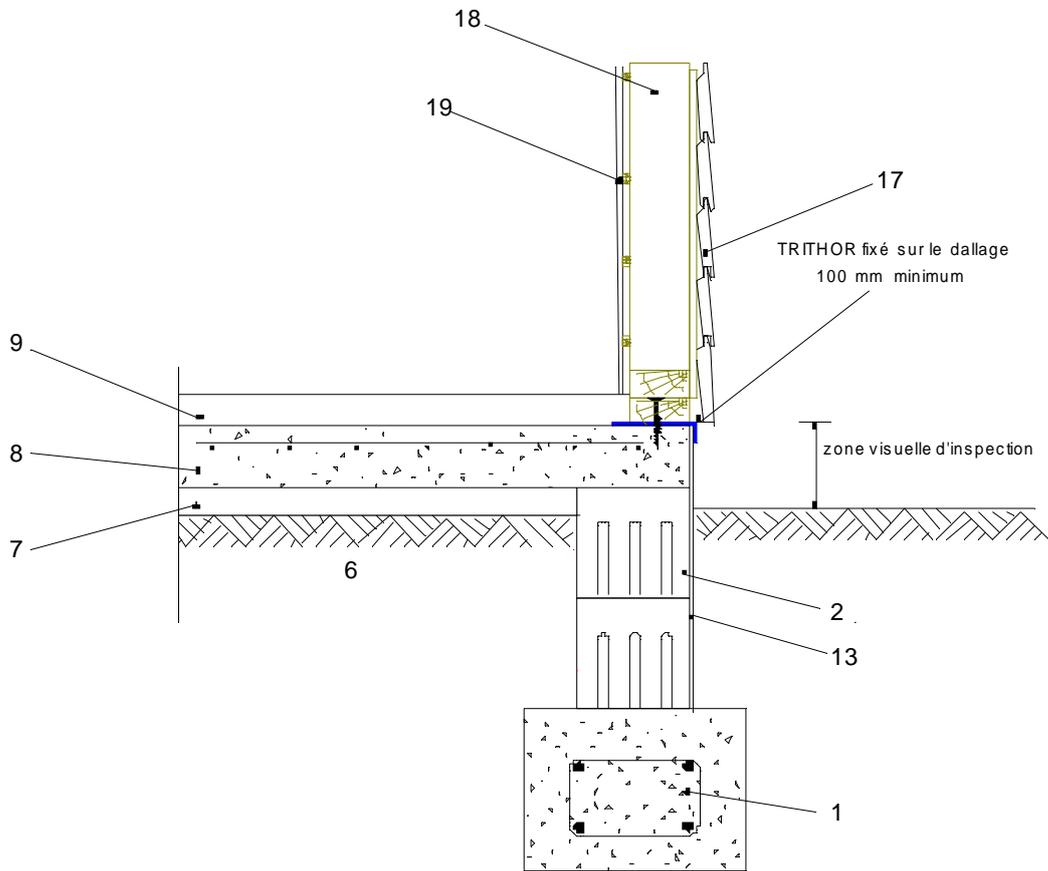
Bâtiment en ossature bois – Sur dallage coffré soubassement enduit (voir détail Figure 11-2 et Figure 12)
